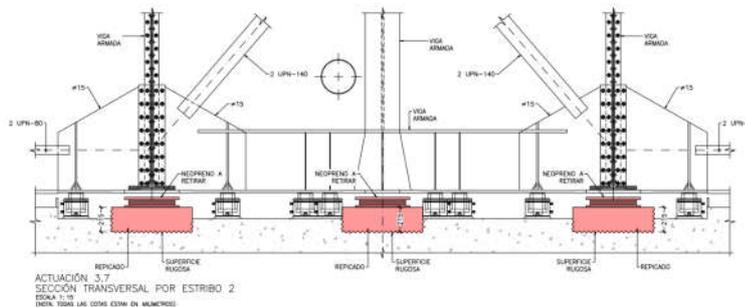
Retirada de neoprenos y repicado de zona bajo apoyos
